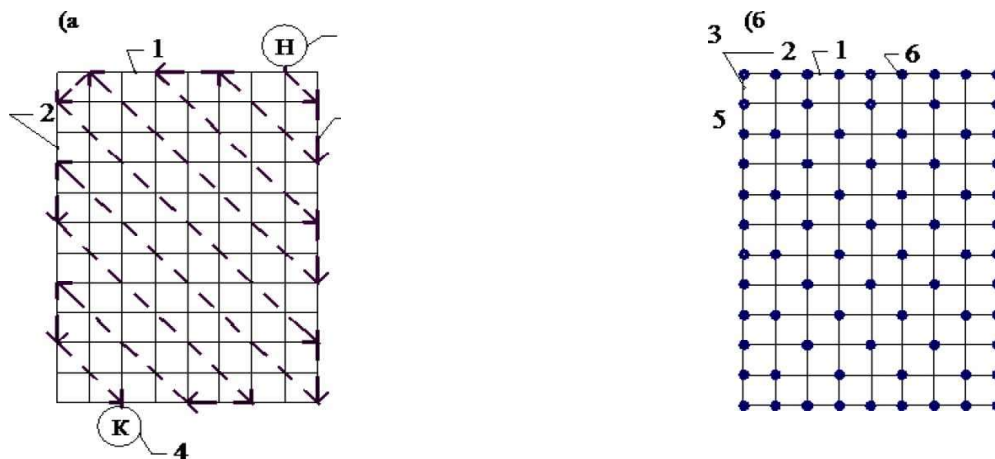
Порядок закрепления арматурных стержней вязальной проволокой: а) схема движения рабочего вязущего пересечения стержней; б) схема закрепления стержней арматурной сетки: 1-поперечные стержни; 2 – продольные стержни; 3 – начало пути рабочего; 4 – окончание пути рабочего; 5-путь движения рабочего; 6 – пересечение арматурных стержней, закрепленное вязальной проволокой
